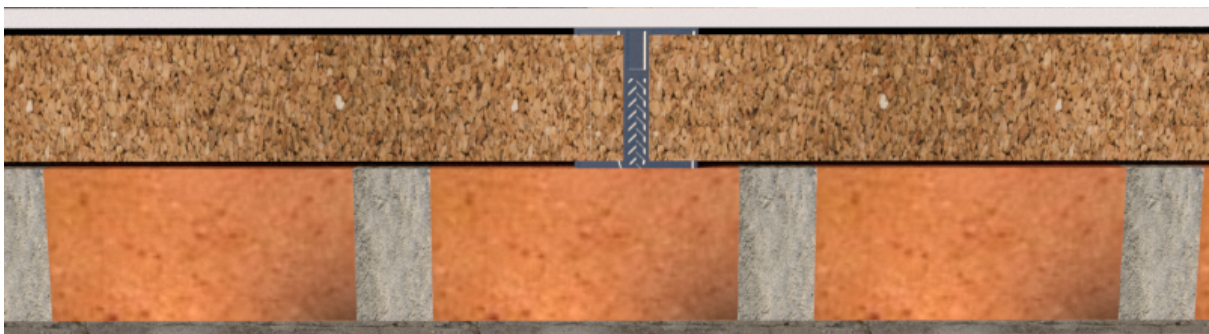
Detalle de muro construido con panel de corcho reciclado y drywall.
